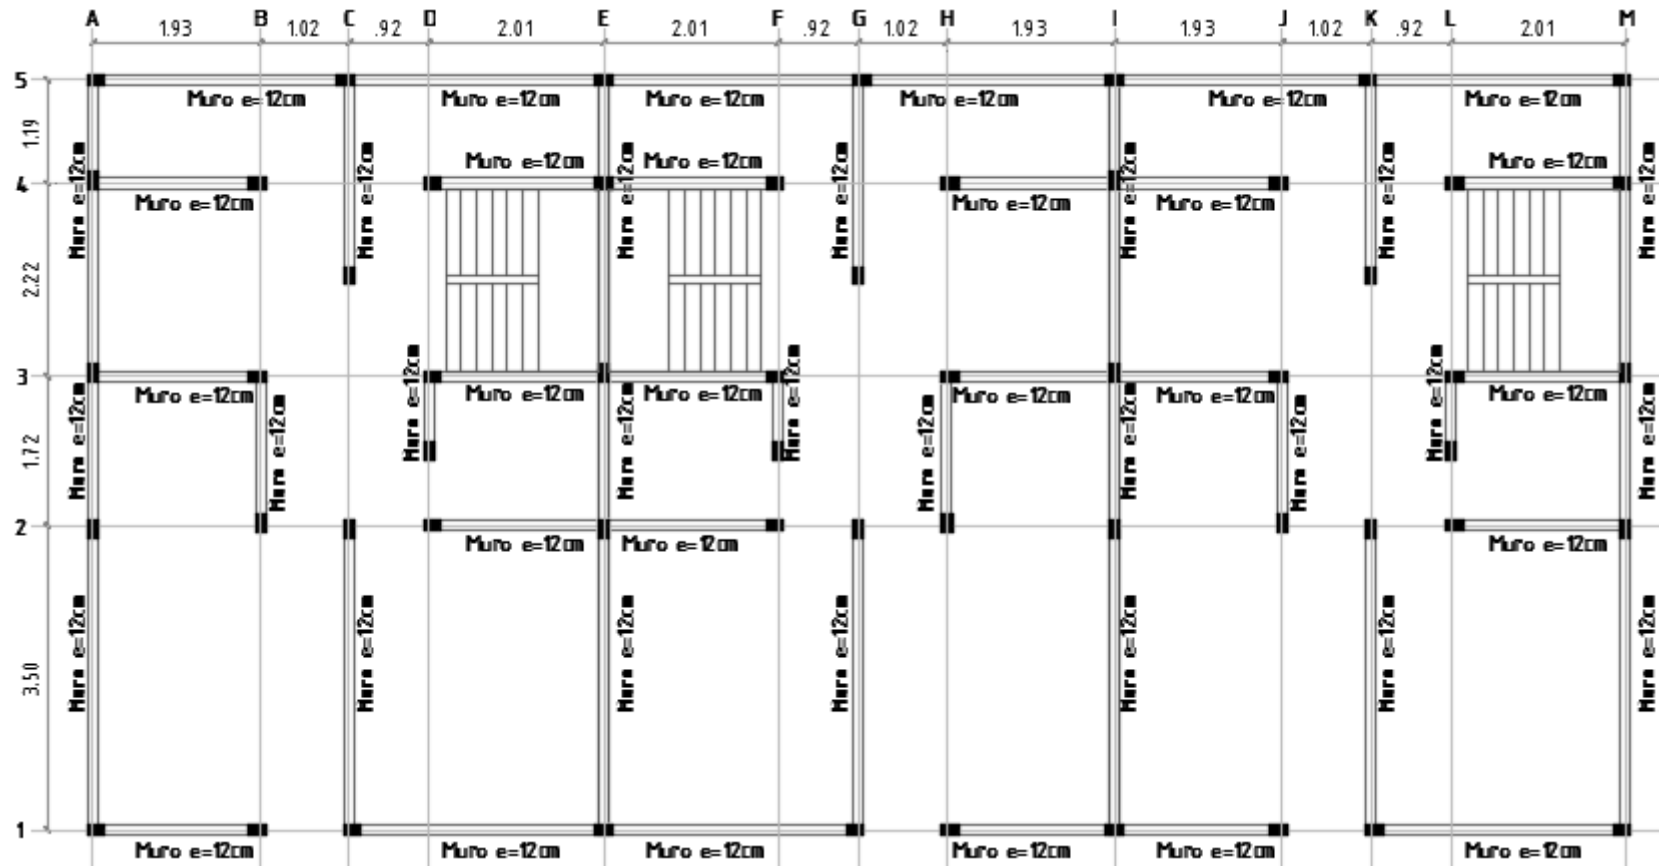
Replanteo estructural muros de mampostería confinada, primer piso
